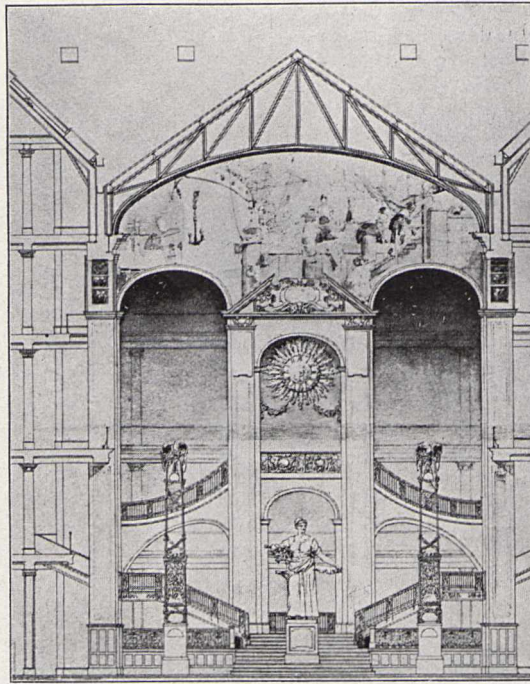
Querschnitt durch den Lichthof Leipzigerstraße 132/133.
